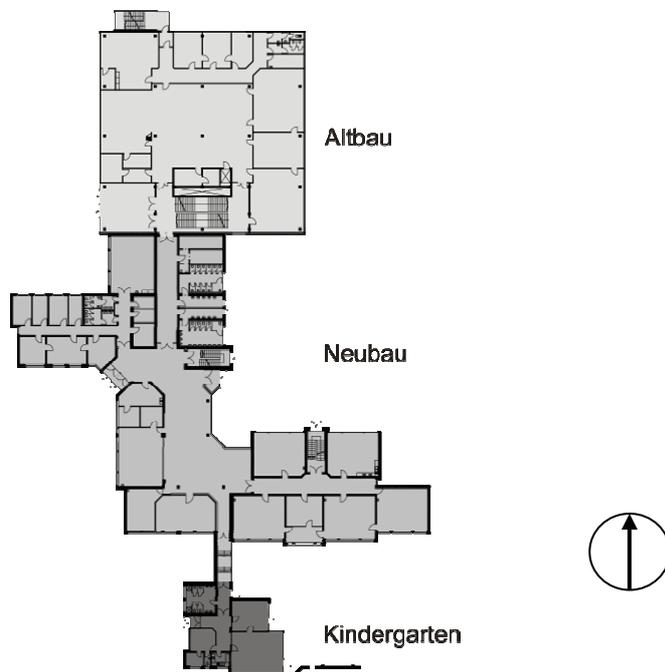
Grundriss EG Regenbogenschule Wolfsburg
